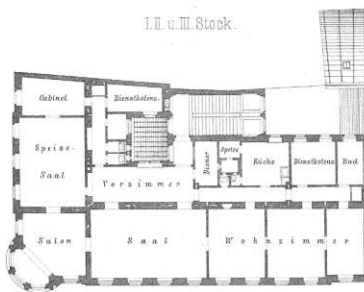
Grundriss 1., 2. und 3. Obergeschoss, Zinshaus Mauthner Ritter von Mauthstein, Kärtnerstraße 49 - Ludwig Tischler, 1883
